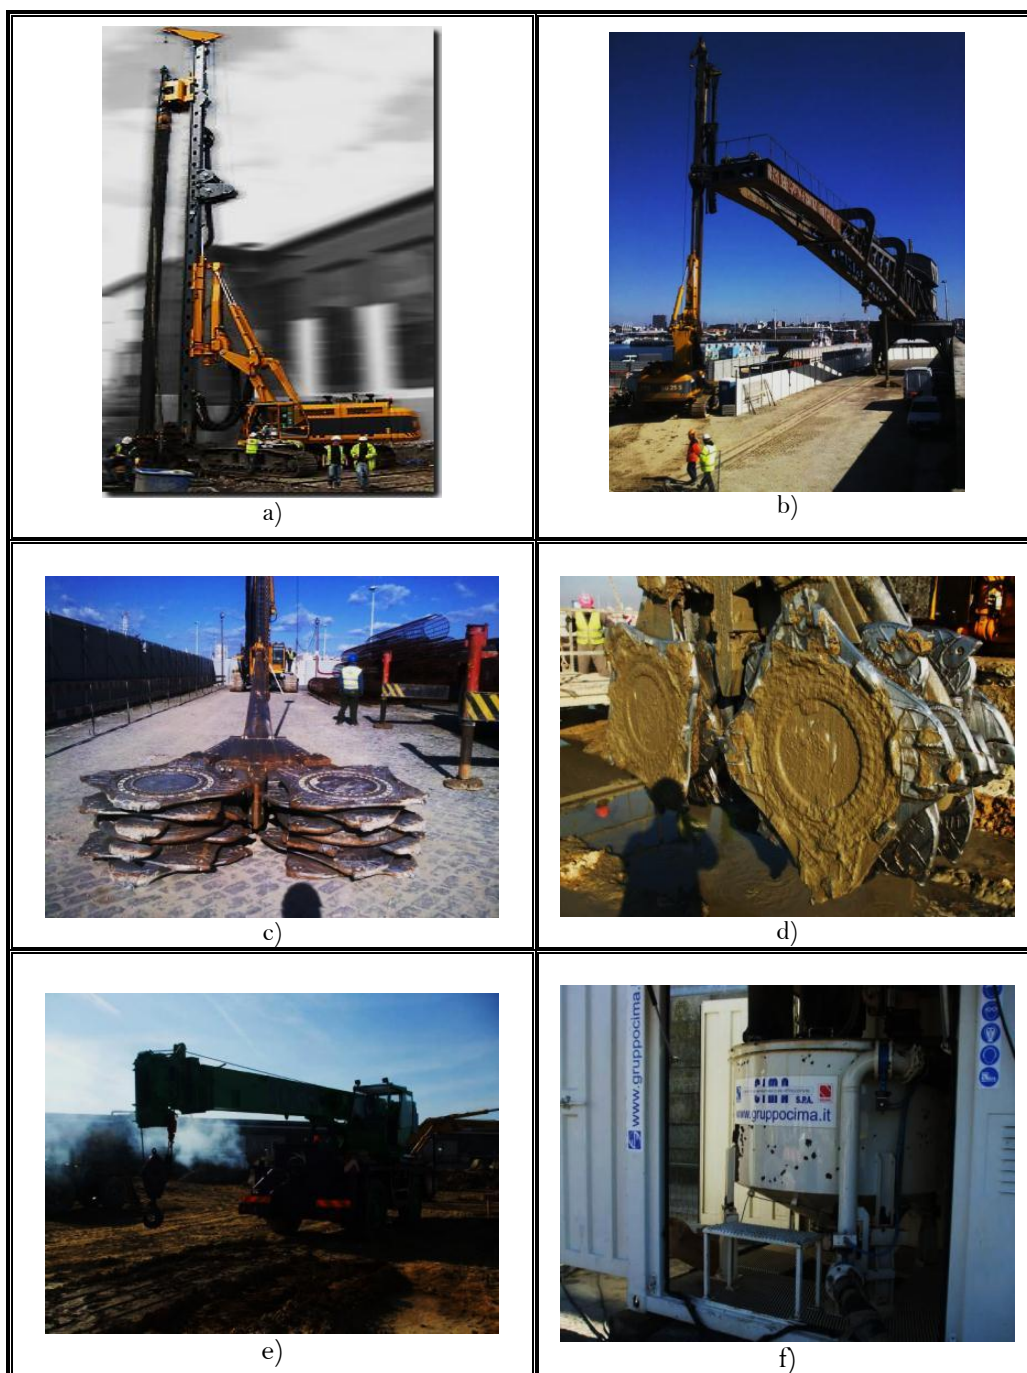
Equipamento necessário para execução dos painéis CSM
